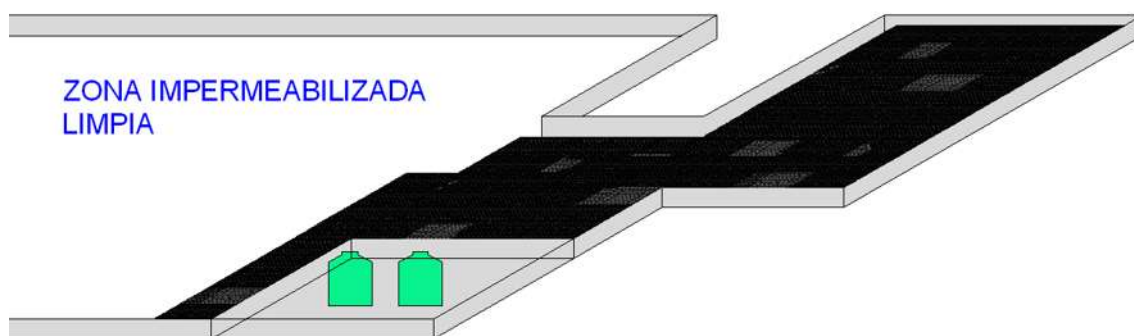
Colocación de las piezas de la capa dren en azotea.
